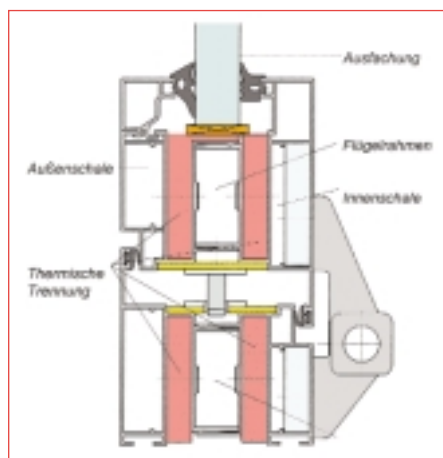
Thermisch getrenntes Aluminiumprofil einer T 30-2-Tür
